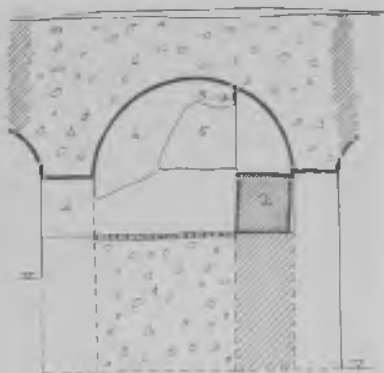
Stanza 7, sezione. 1: pavimento rialzato; 2: muro di sostegno; 3: frammento d'intonaco sulla parete NE; 4: porta murata in comunicazione con la stanza 8; 5: finestra murata; 6: intonaco.
